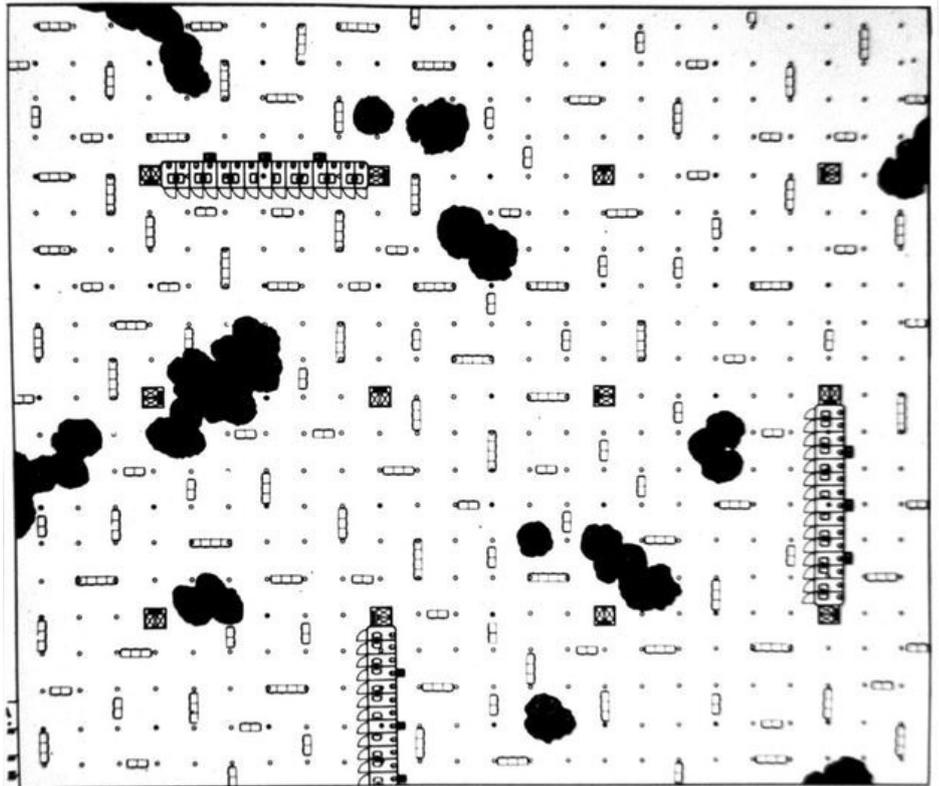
Archizoom, Non-Stop-City, Grundriss
